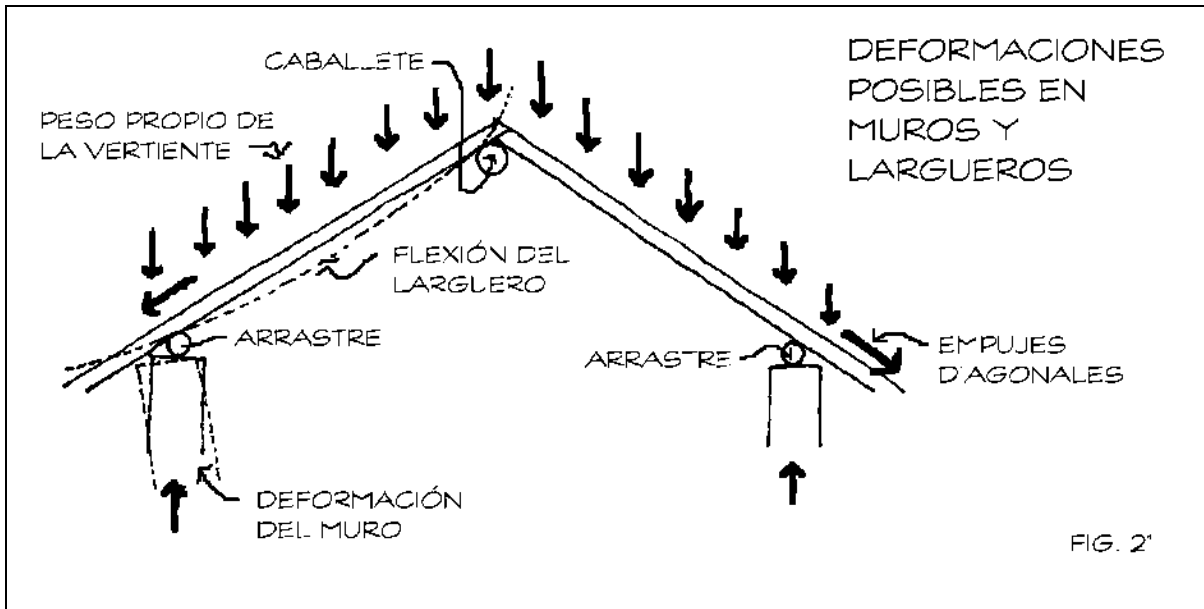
(1).- Detalle de la cubierta de madera y su comportamiento estructural. croquis: autor Dr. Luis Alberto Torres Garibay.
